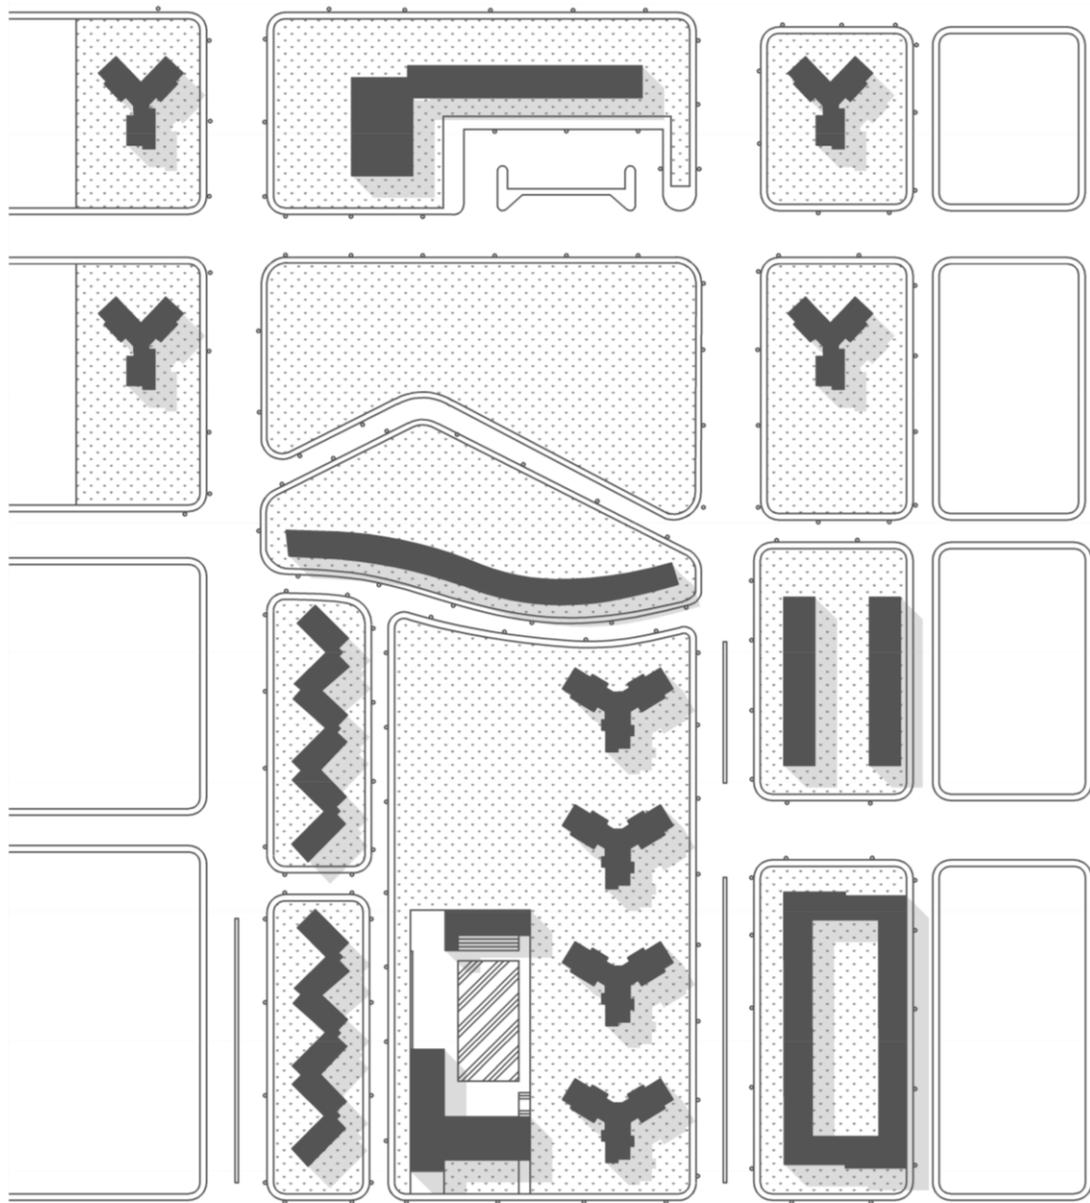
Planta del conjunto, Plan Parcial Modificado, 1972. Elaboración propia.
